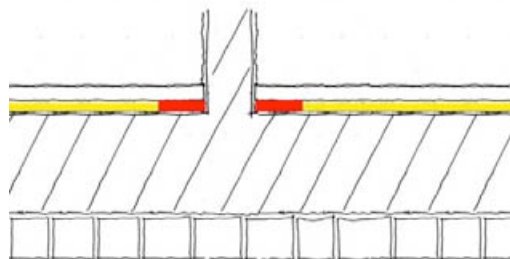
Grundriss mit Anschluss Innenwand
